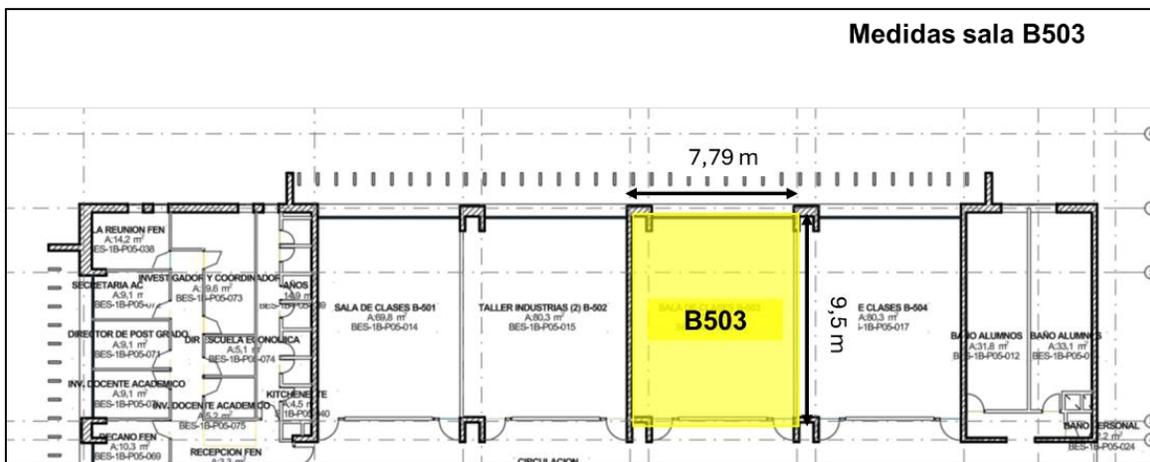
Dimensiones en metros sala B503 Sede Bellavista Sede Bellavista - AutoCAD
